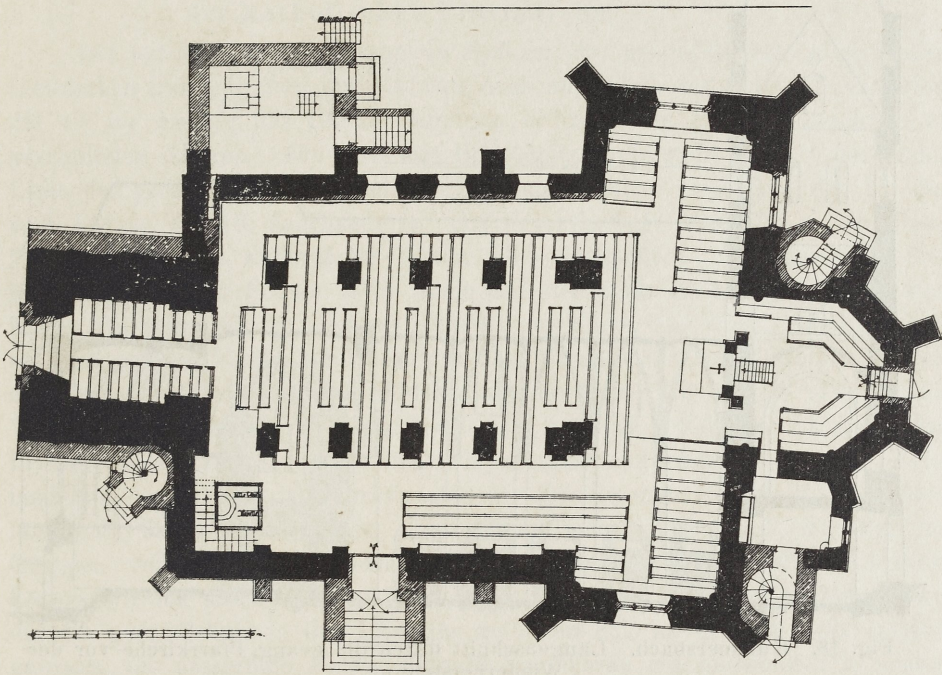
Gummerslach. Grundriss der evang. Pfarrkirche nach der Wiederherstellung.
